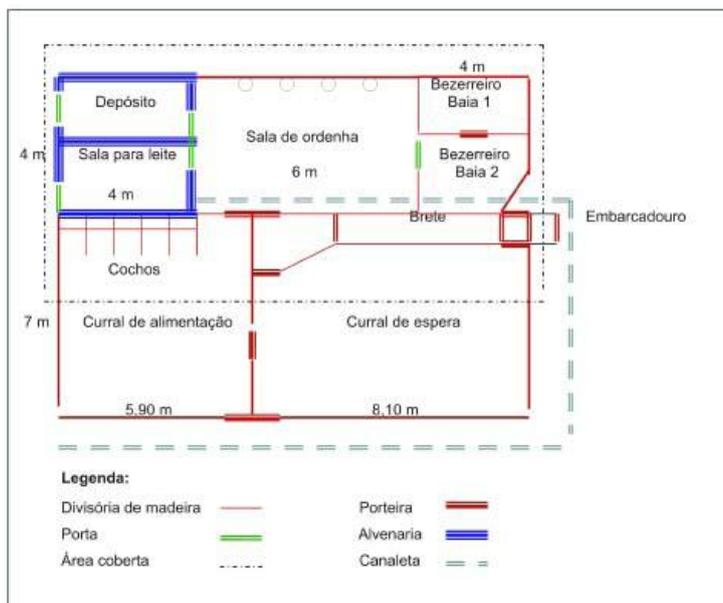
Planta de um estábulo com instalações para manejo de rebanho leiteiro. Fonte: EMBRAPA, 2009.
